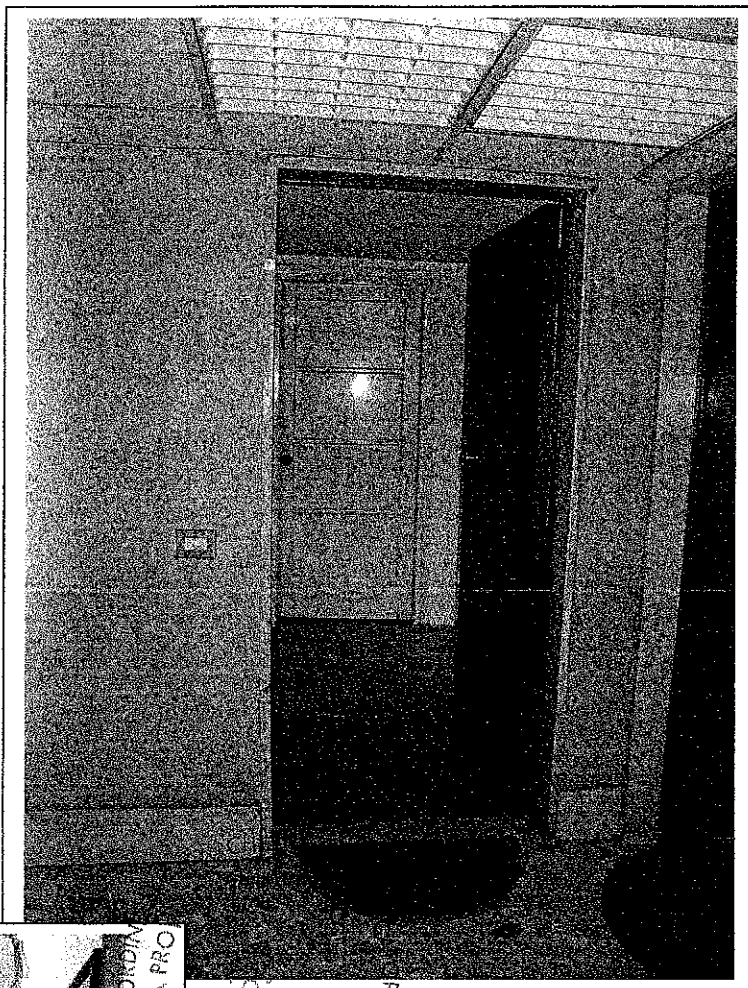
Vista del pianerottolo al piano seminterrato – sul fondo al centro la porta d'ingresso all'ufficio oggetto della presente.
